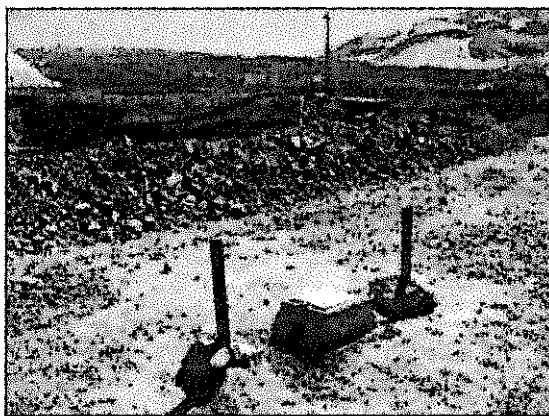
Instalación de Piezómetro PZ - 03, ubicado de la parte baja de las Pozas PLS-ILS.
